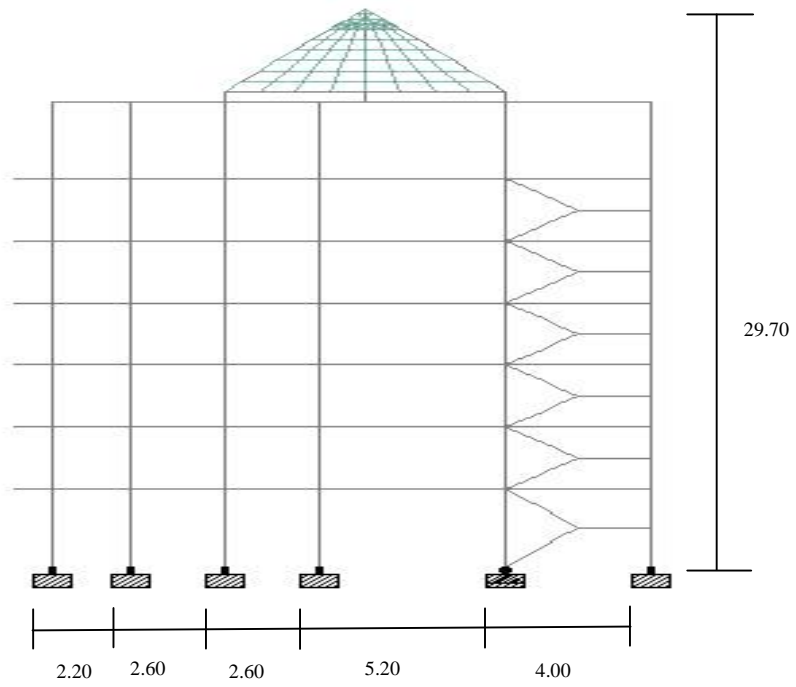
Denah Balok Lantai 1-7 / Line 10-14
